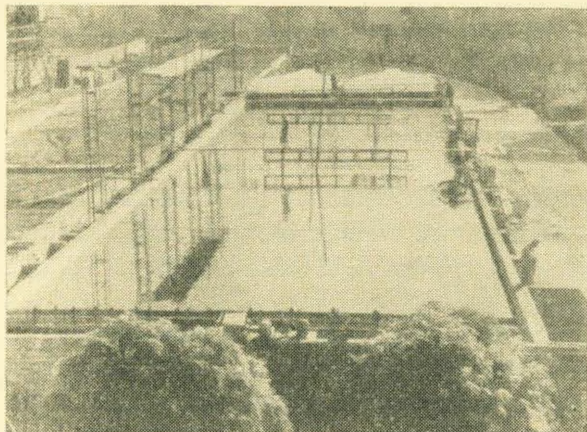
Общий вид опытного бассейна в Норкской лаборатории ИВП.
